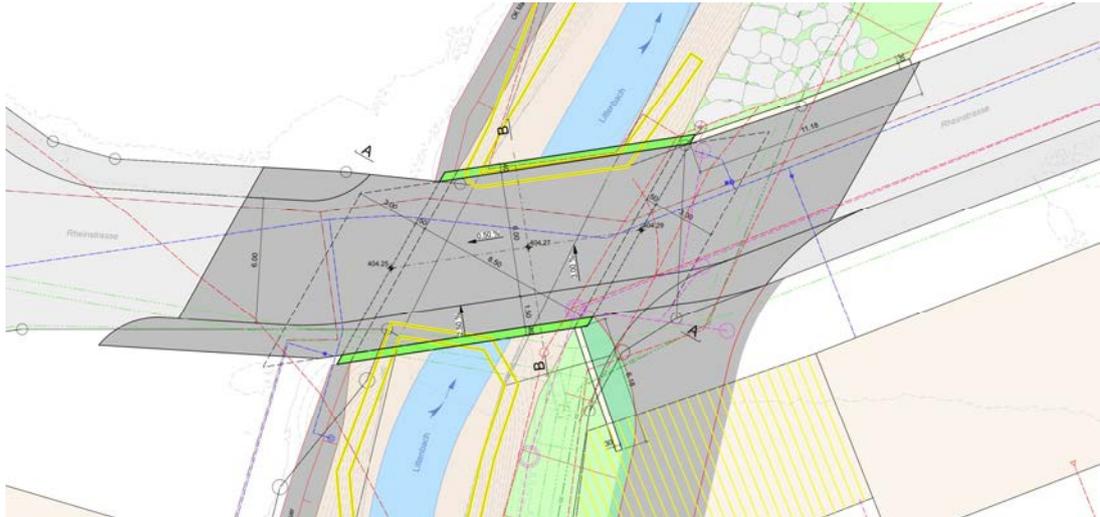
Horizontale Linienführung der Brücke Rheinstrasse, Littenbach
